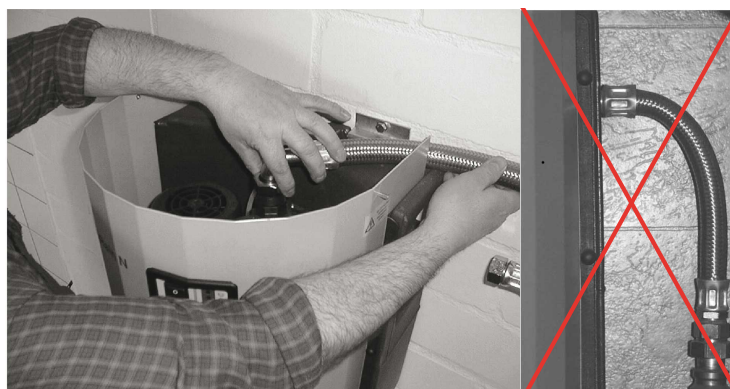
Pumpenaggregat fixieren und in Formstück führen
